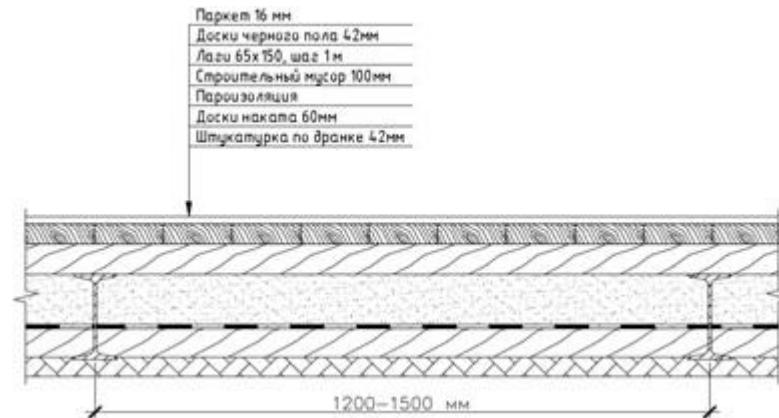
Наиболее часто встречаемая конструкция междуэтажного перекрытия по металлическим балкам в старом фонде
